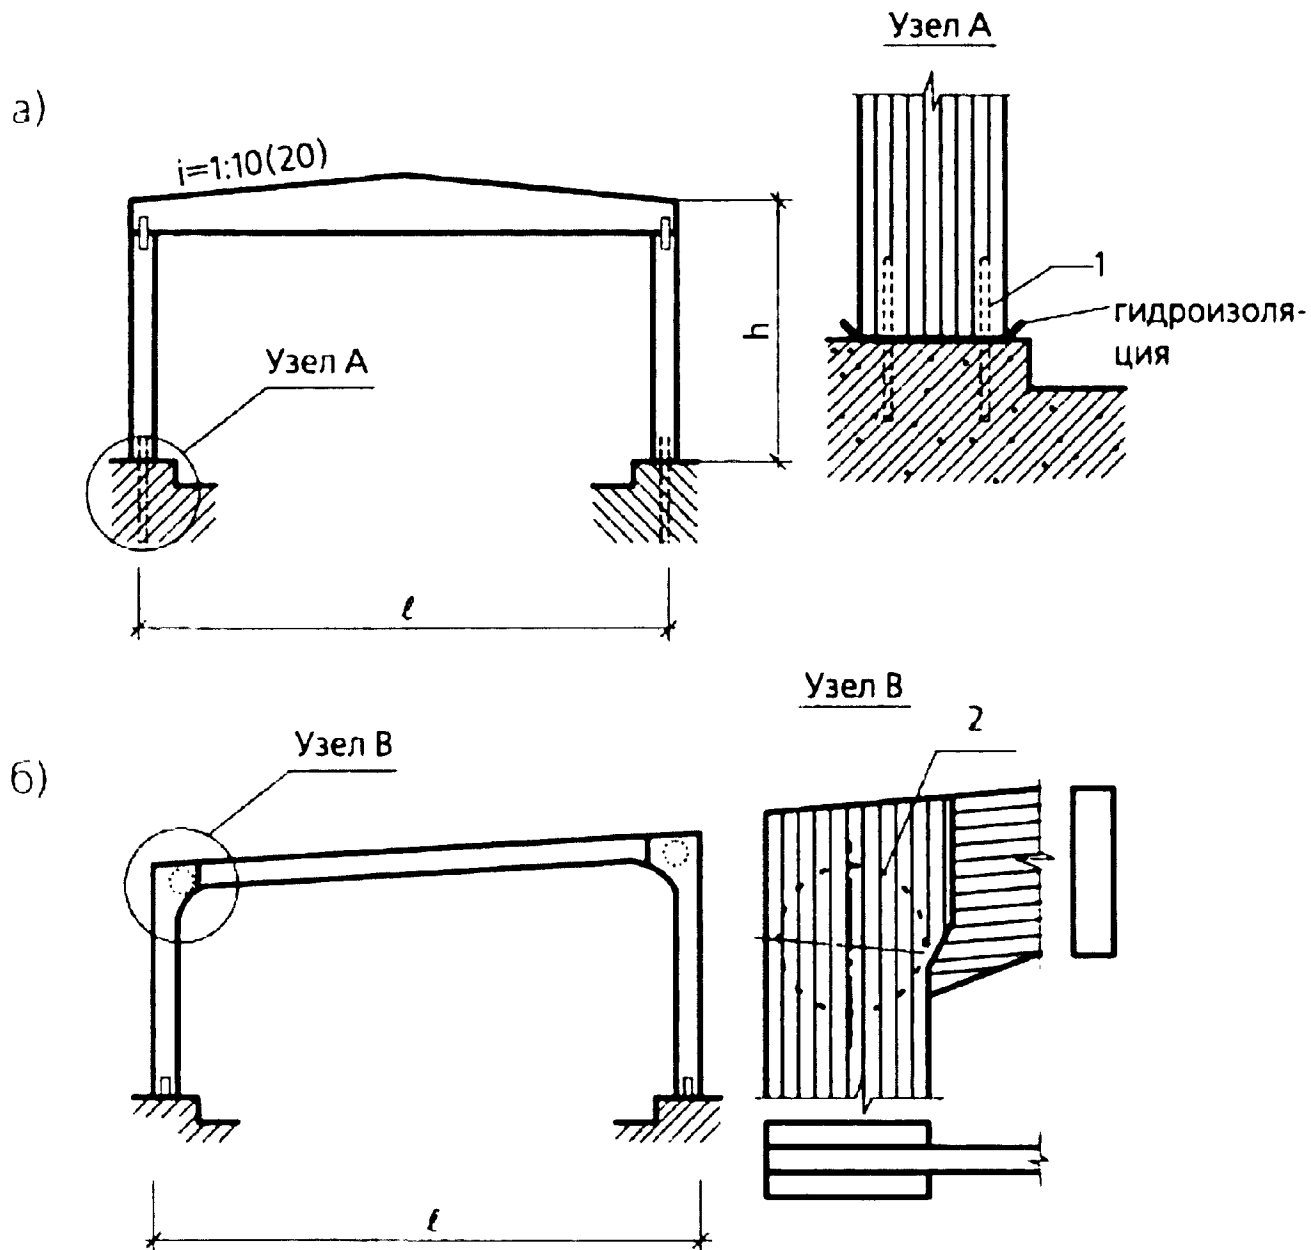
Двухшарнирные рамы: а - с жестко закрепленными в основании стойками; б - жесткими карнизными узлами: 1 - клеестержневое соединение (арматура, вклеенная в древесину с помощью клея ЭПЦ-1), 2 - нагельное соединение
